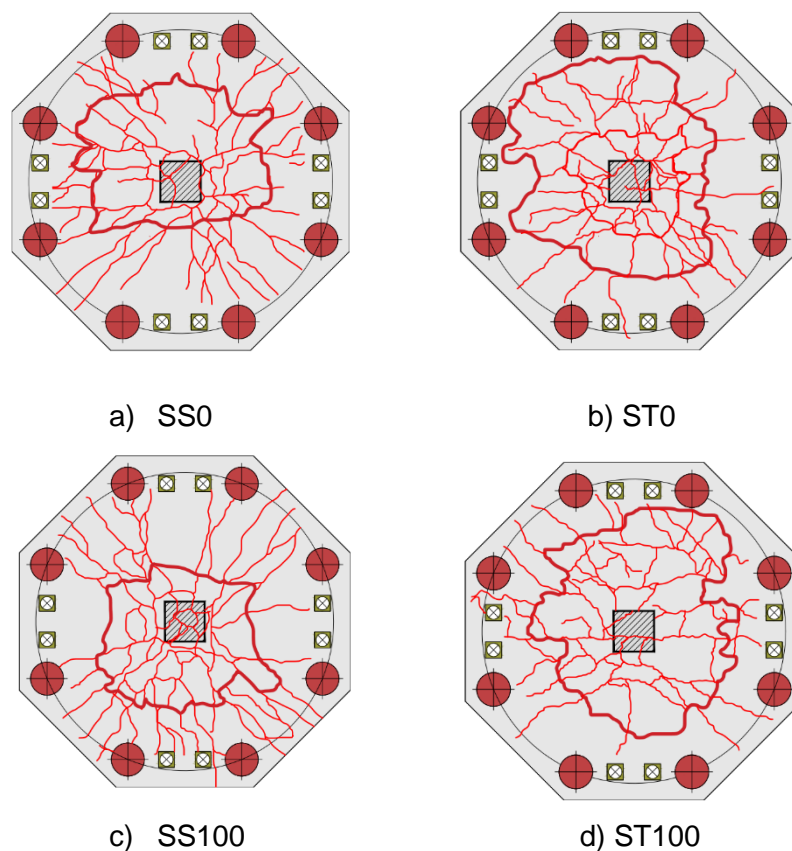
Mapa de fissuração das lajes (Autora, 2023).
